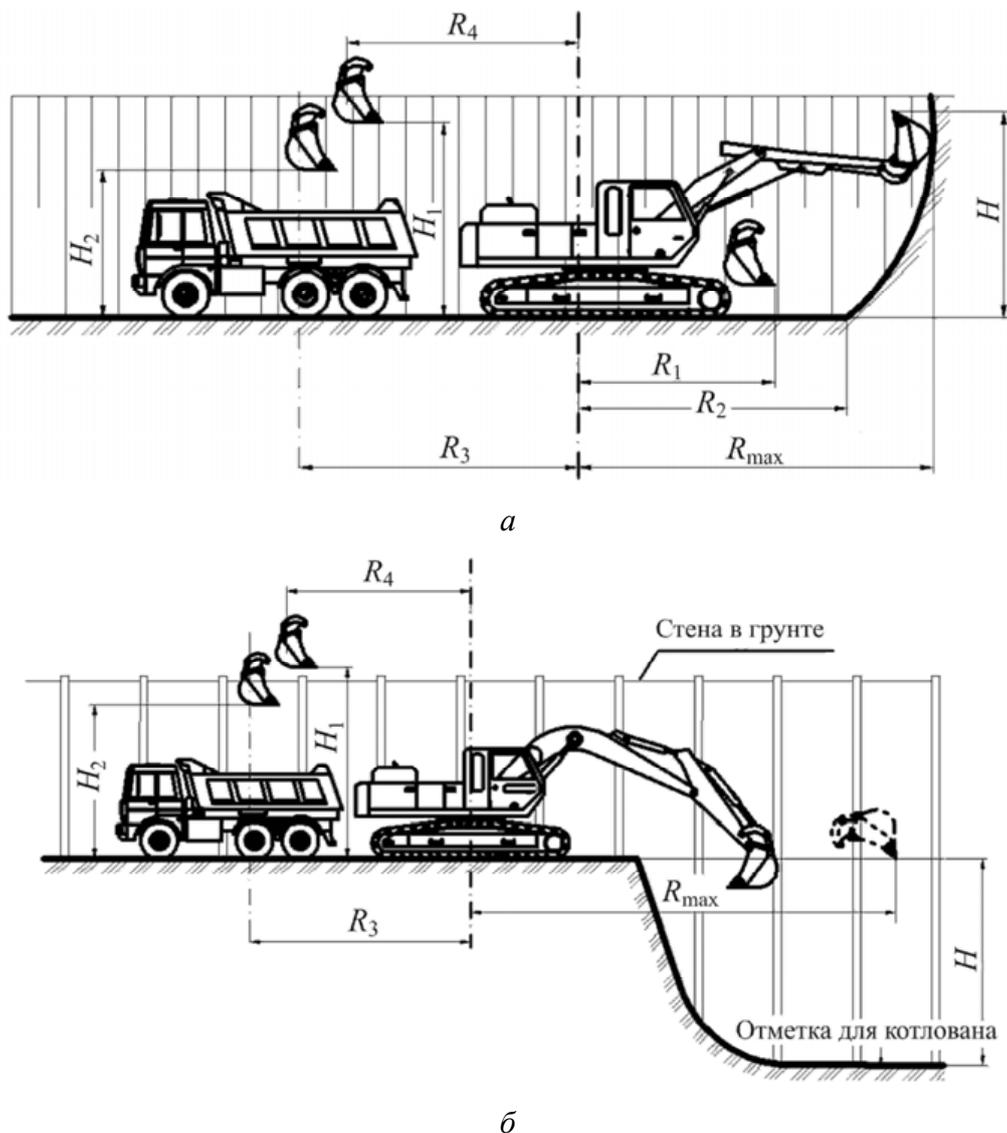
Размерные параметры экскаватора: а — прямая лопата; б — обратная лопата
